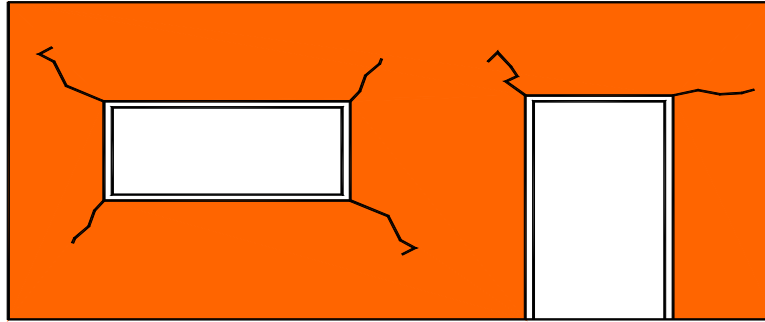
Fissuração típica (real) nos cantos das aberturas, sob actuação excessiva de cargas [30]
